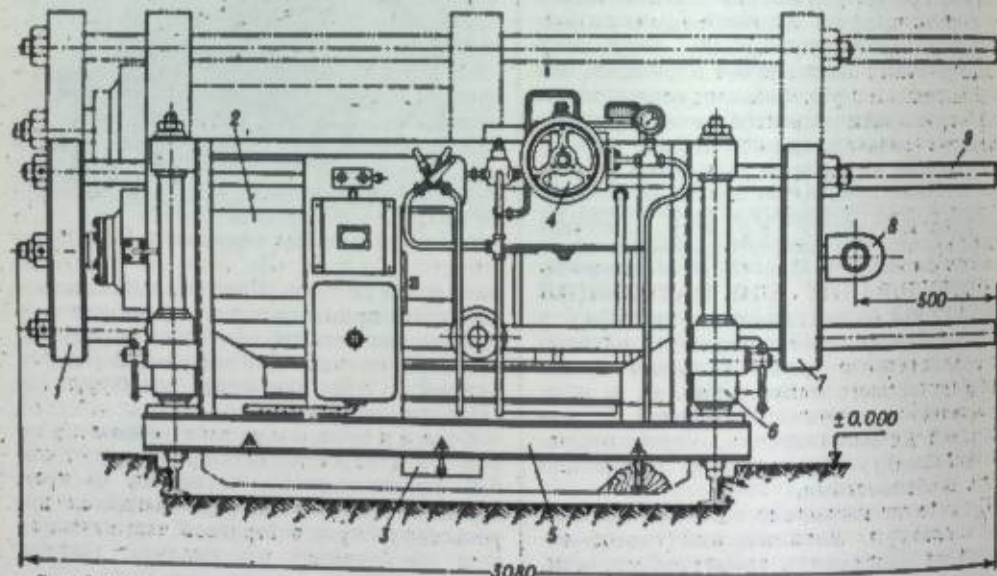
Гидродомкрат для стенов: 1 — задняя траверса; 2 — цилиндр натяжения; 3 — цилиндр подъема домкрата; 4 — золотниковый вран; 5 — рама; 6 — рама подъема; 7 — передняя траверса; 8 — серьга; 9 — упорные сналки.
